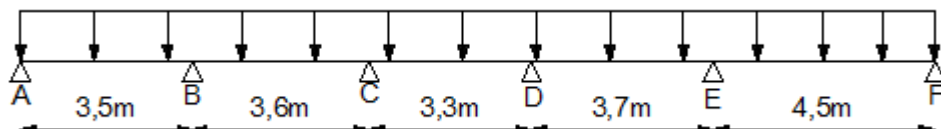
schéma statique de la poutre reposant sur six appuis.
